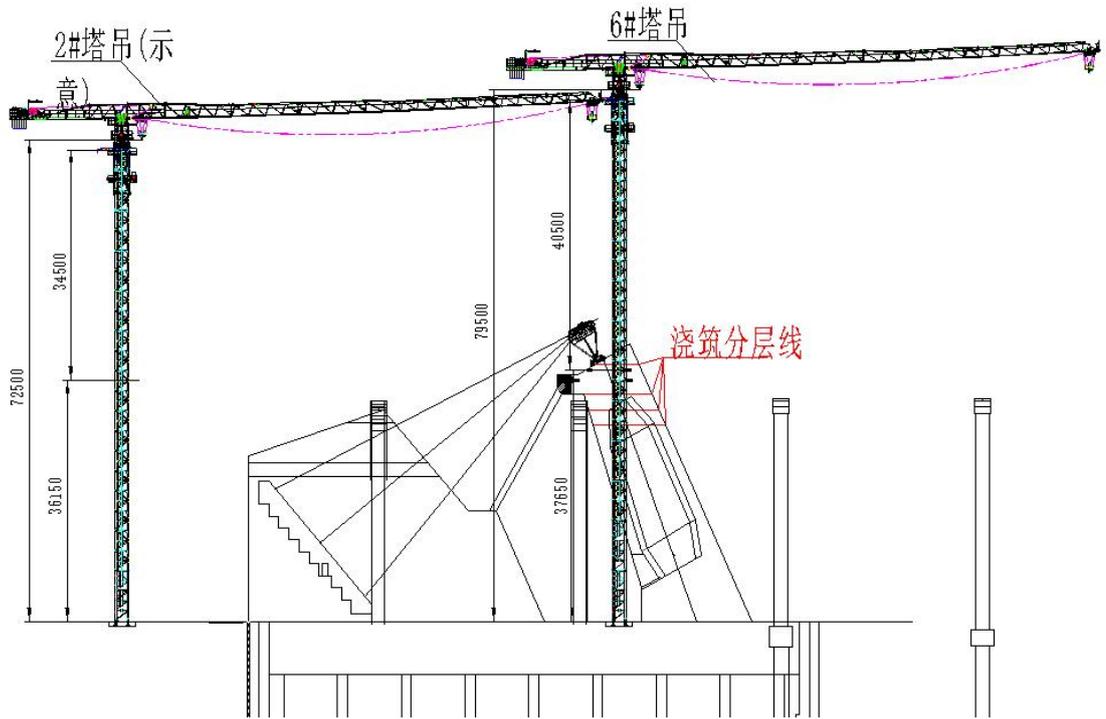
设备在锚体施工时立面布置图 (mm)
